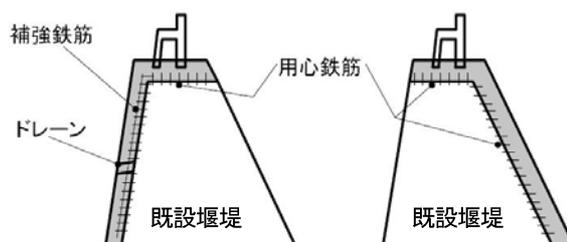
新旧コンクリート及びコンクリート・鋼材部の一体化
